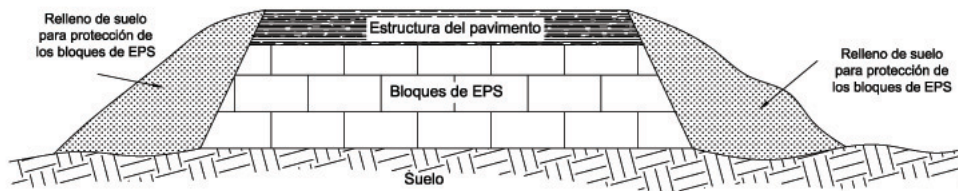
Componentes principales de un terraplén aligerado con bloques de EPS
